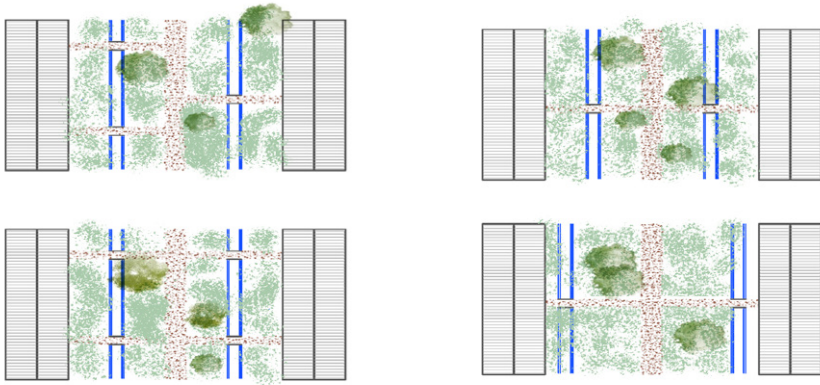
Plans schématiques des relations entre l'extérieur et les rez-de-chaussée.
